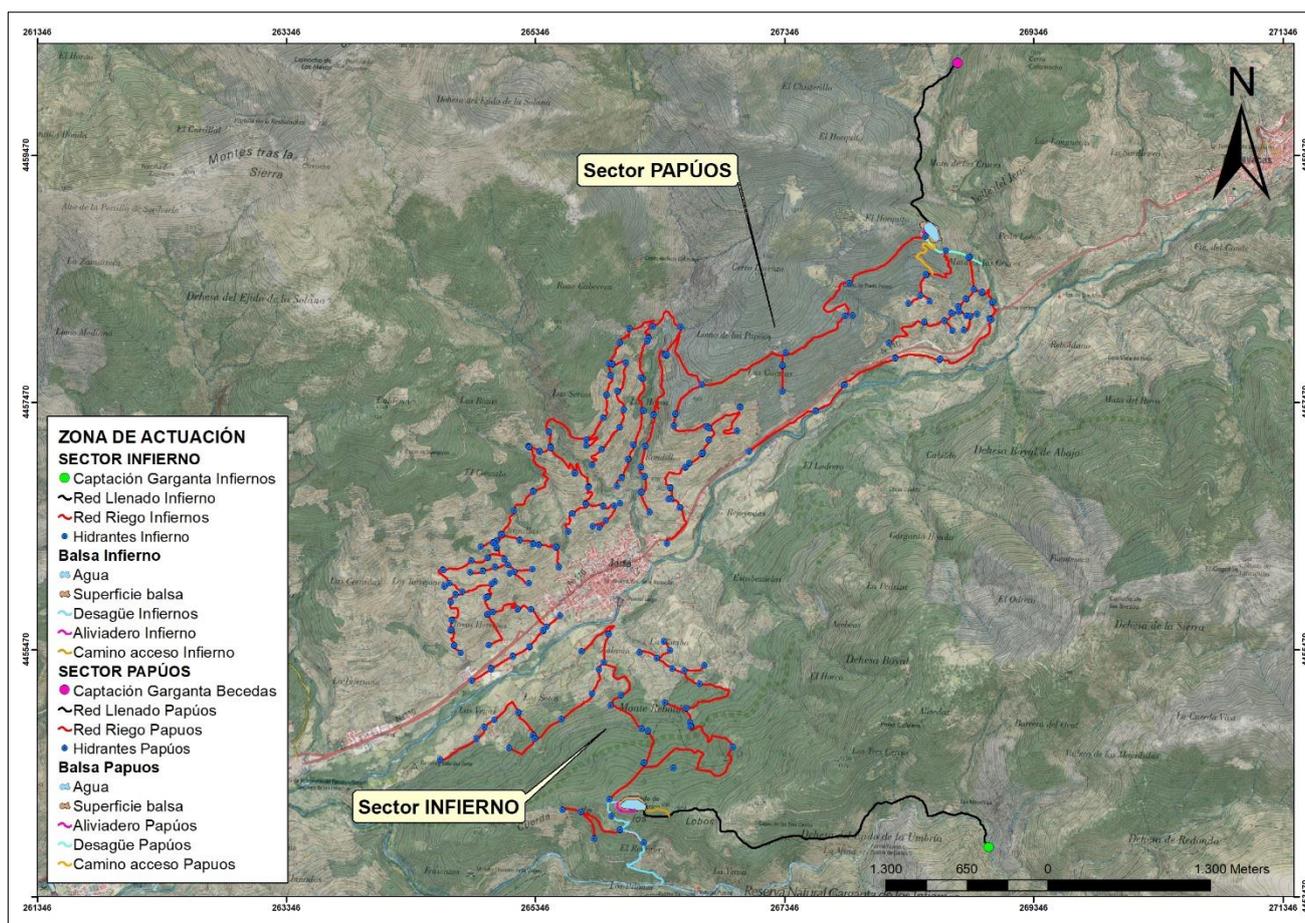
Plano detalle zona de actuación. Fuente: Elaboración propia, 2023.
